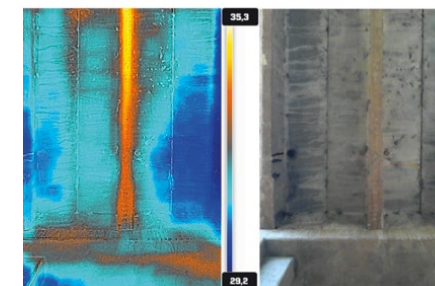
Eflorescencias en vigas principales, sección N.º 8
